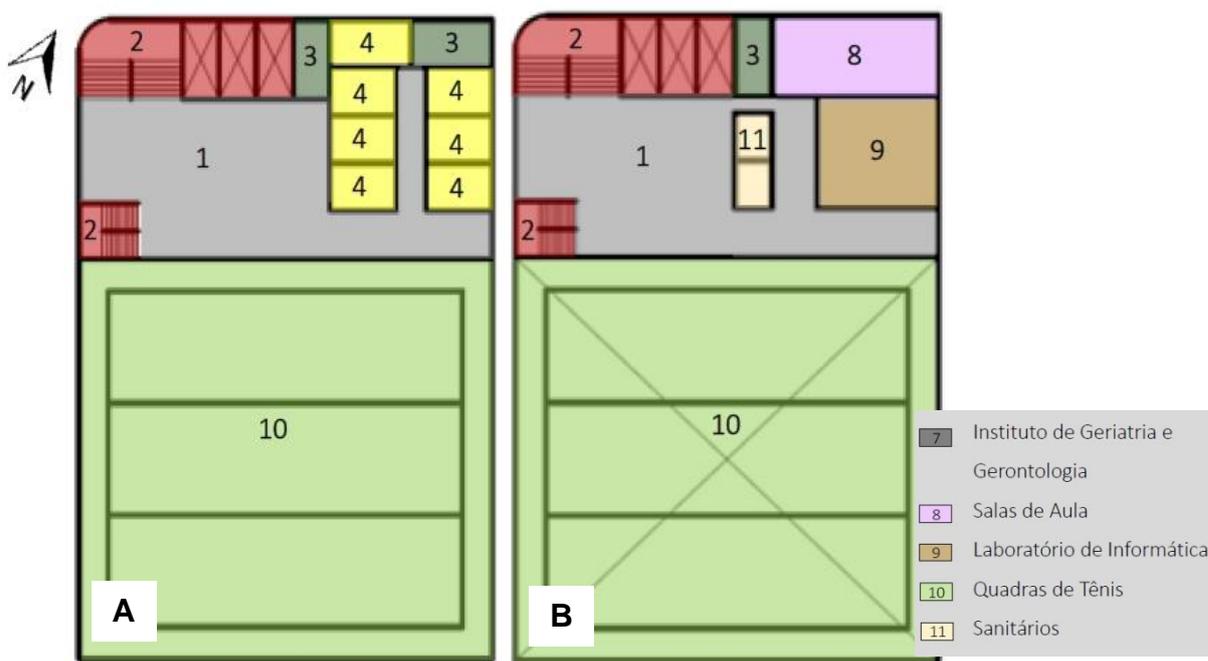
A) Planta baixa 8º pavimento. B) Planta baixa 9º Pavimento. Fonte: Volpato 2018. Editado pelo autor. Acesso em: 11/05/2018.
